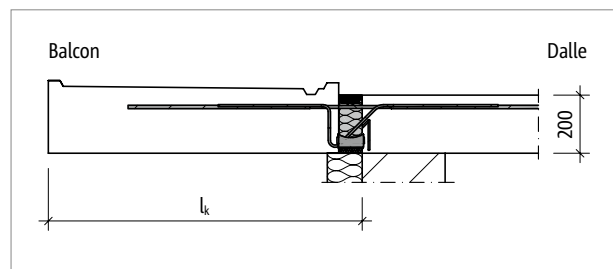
Schöck Isokorb® T Type K-E, K-T : Système statique, coupe
